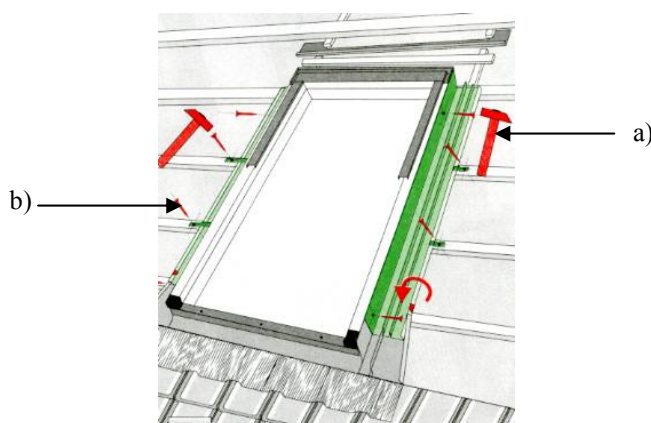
Montaż dolnego elementu kołnierza [5, s. 149].
